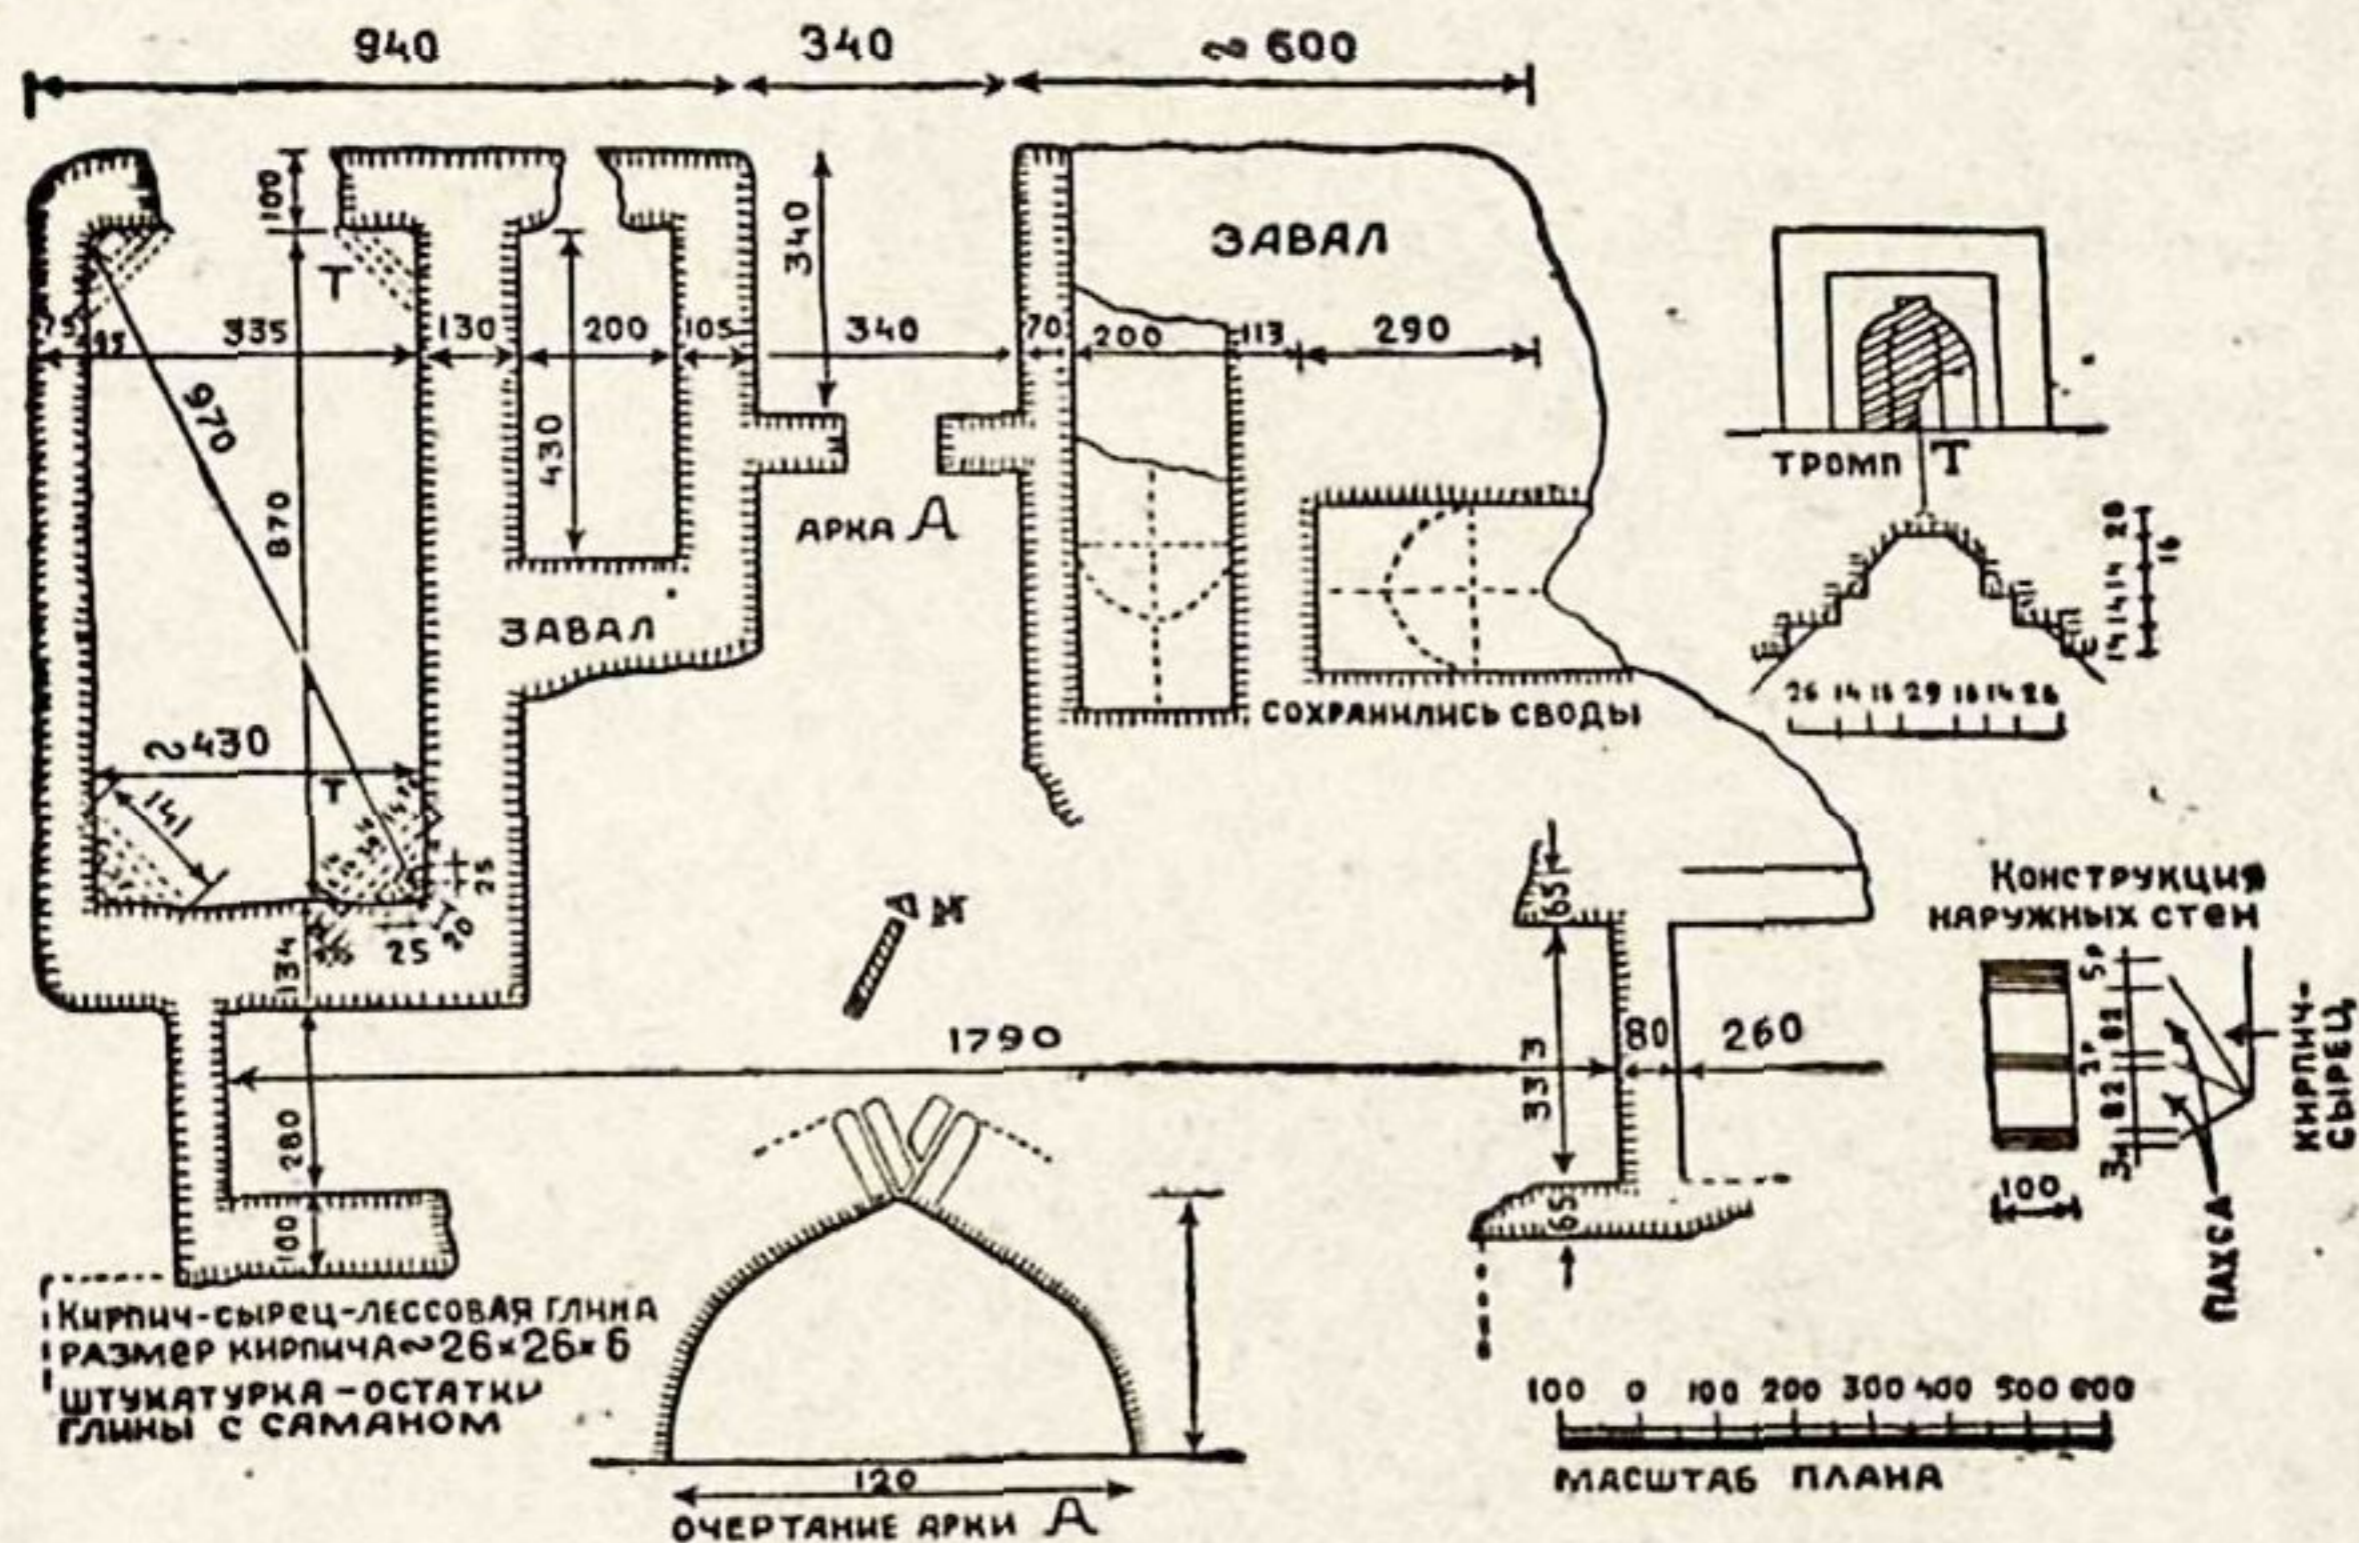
План сырцового здания № 11 и обмеры деталей.
